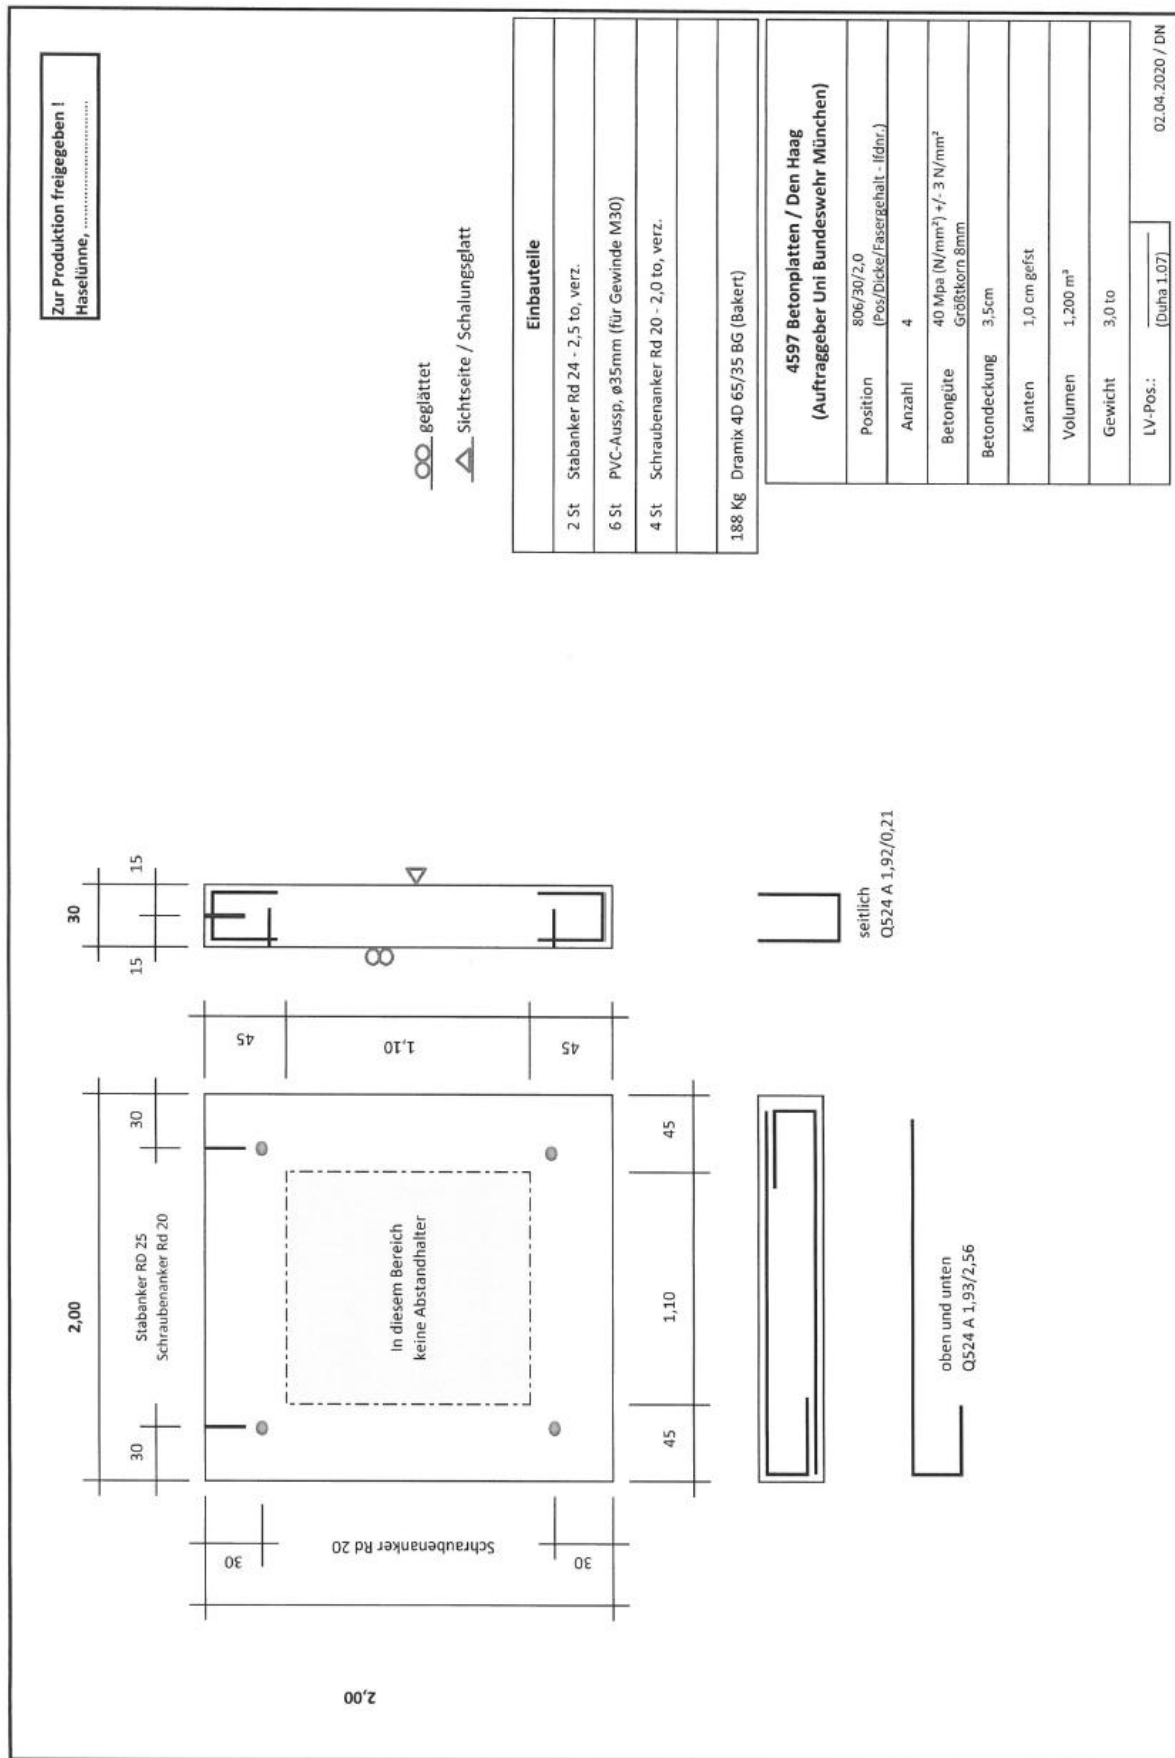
Bewehrungsplan für Stahlfaserbetonplatte mit 2,0 Vol.-% Fasergehalt.
